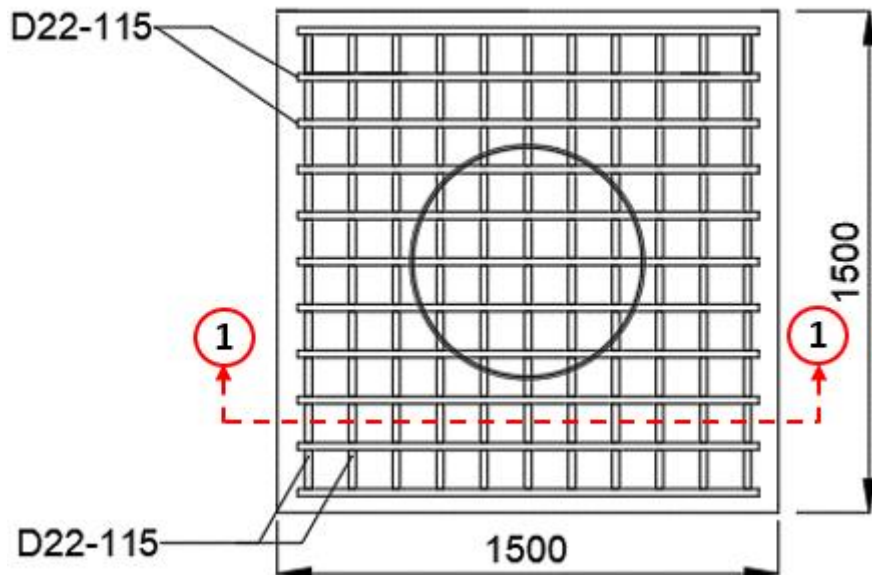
Detail Desain Tulangan *Pile Cap Crane* Tampak Atas
